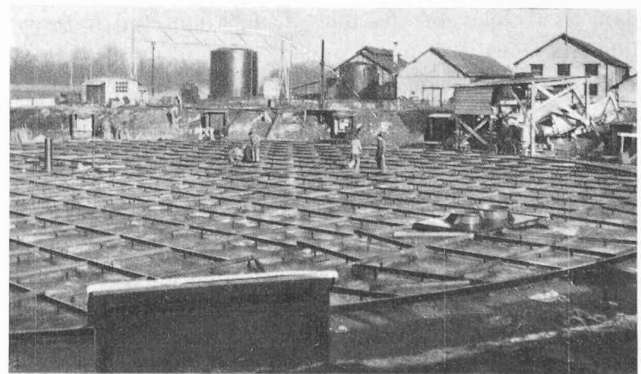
Quadrillage des poutrelles du fond de la cuve.
